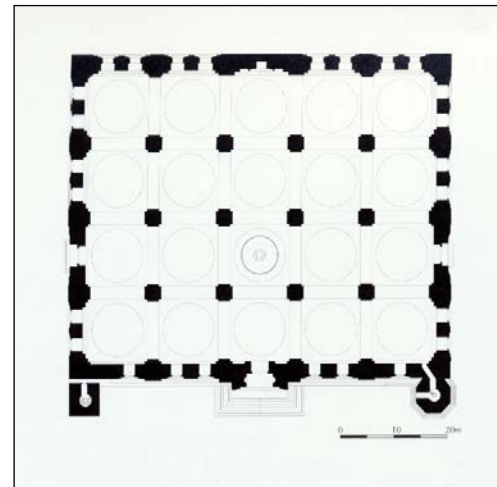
Ulu Cami, Bursa, Grundriss
